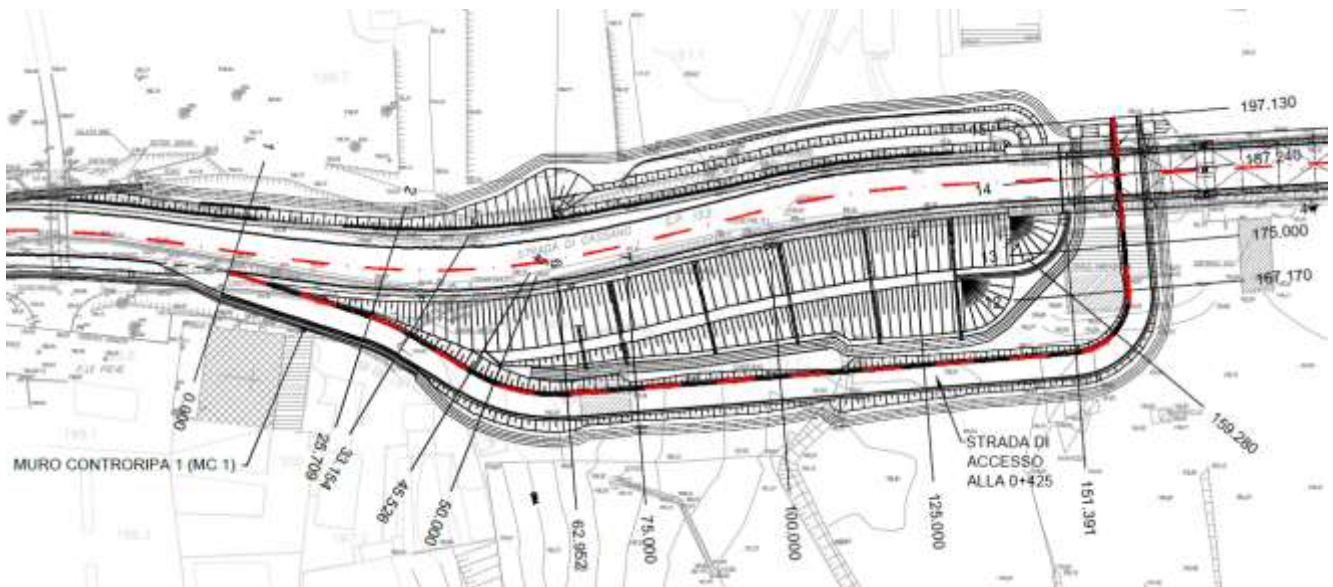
Stralcio planimetria dell'accesso alla 0+425
